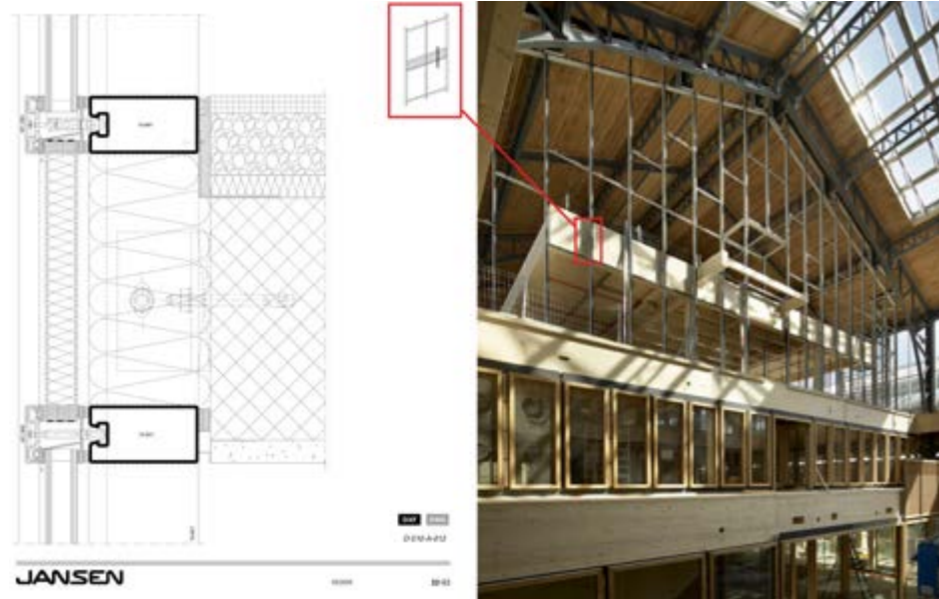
photo et détail de la connexion du mur-rideau en acier et de la structure porteuse au plancher intermédiaire en CLT (Source : Toon Grobet)
